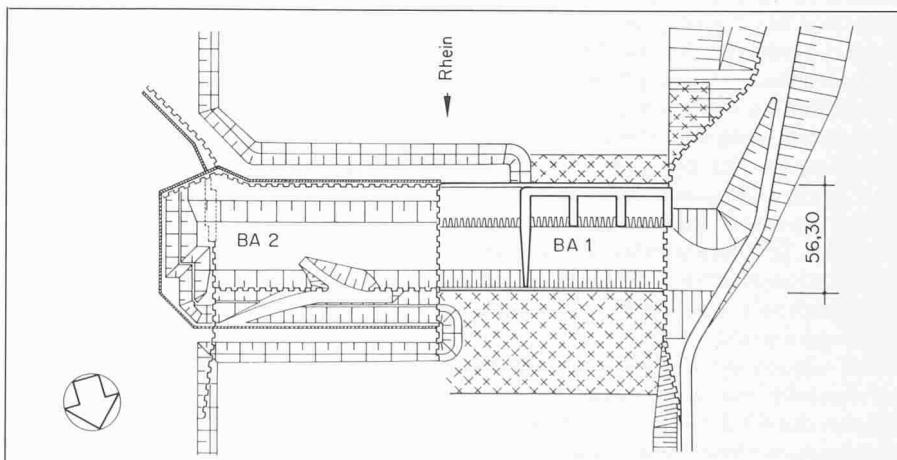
Lageplan mit Baugrube, 2. Bauabschnitt
